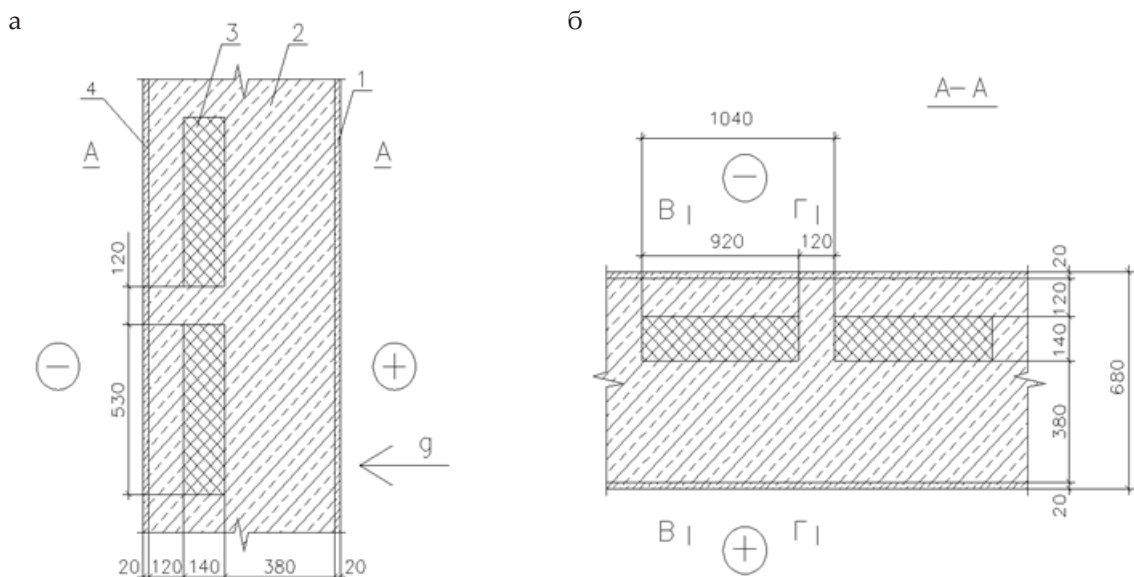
Фрагмент наружной стены: а – сечение по стене; б – план кладки
